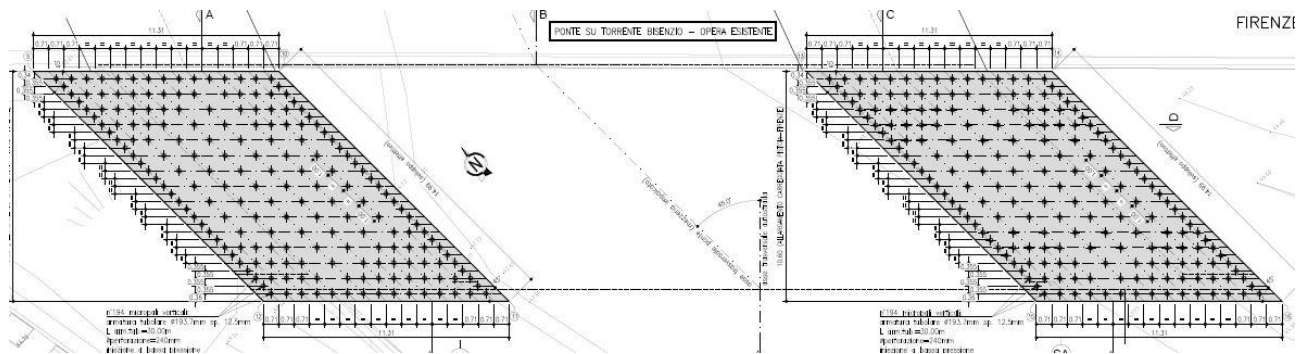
Planimetria di progetto opere di fondazione.
